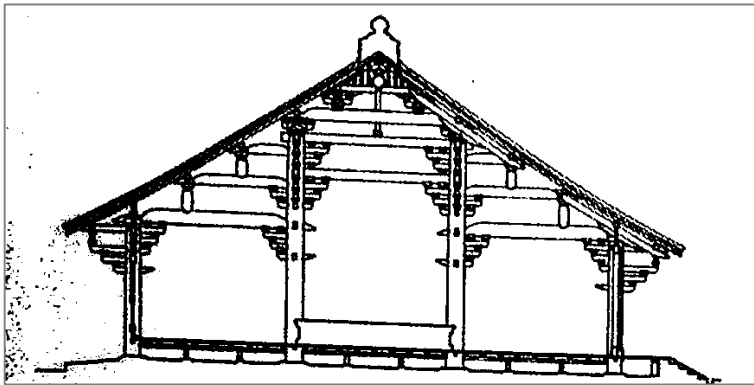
Exemplo de uma construção tradicional japonesa, em corte
